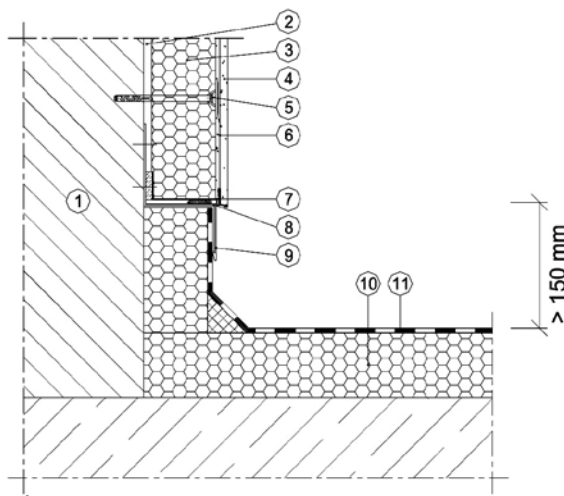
Wärmedämmung mit zurückweichendem (nicht isoliertem) Sockel
